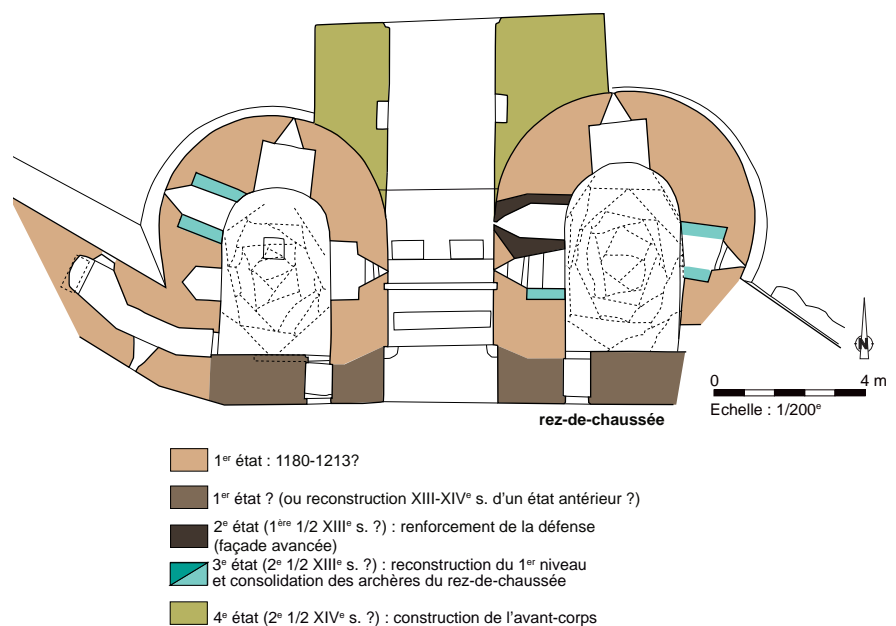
Plan du rez-de-chaussée de l'avant-corps © E. Cadiou, Inrap
